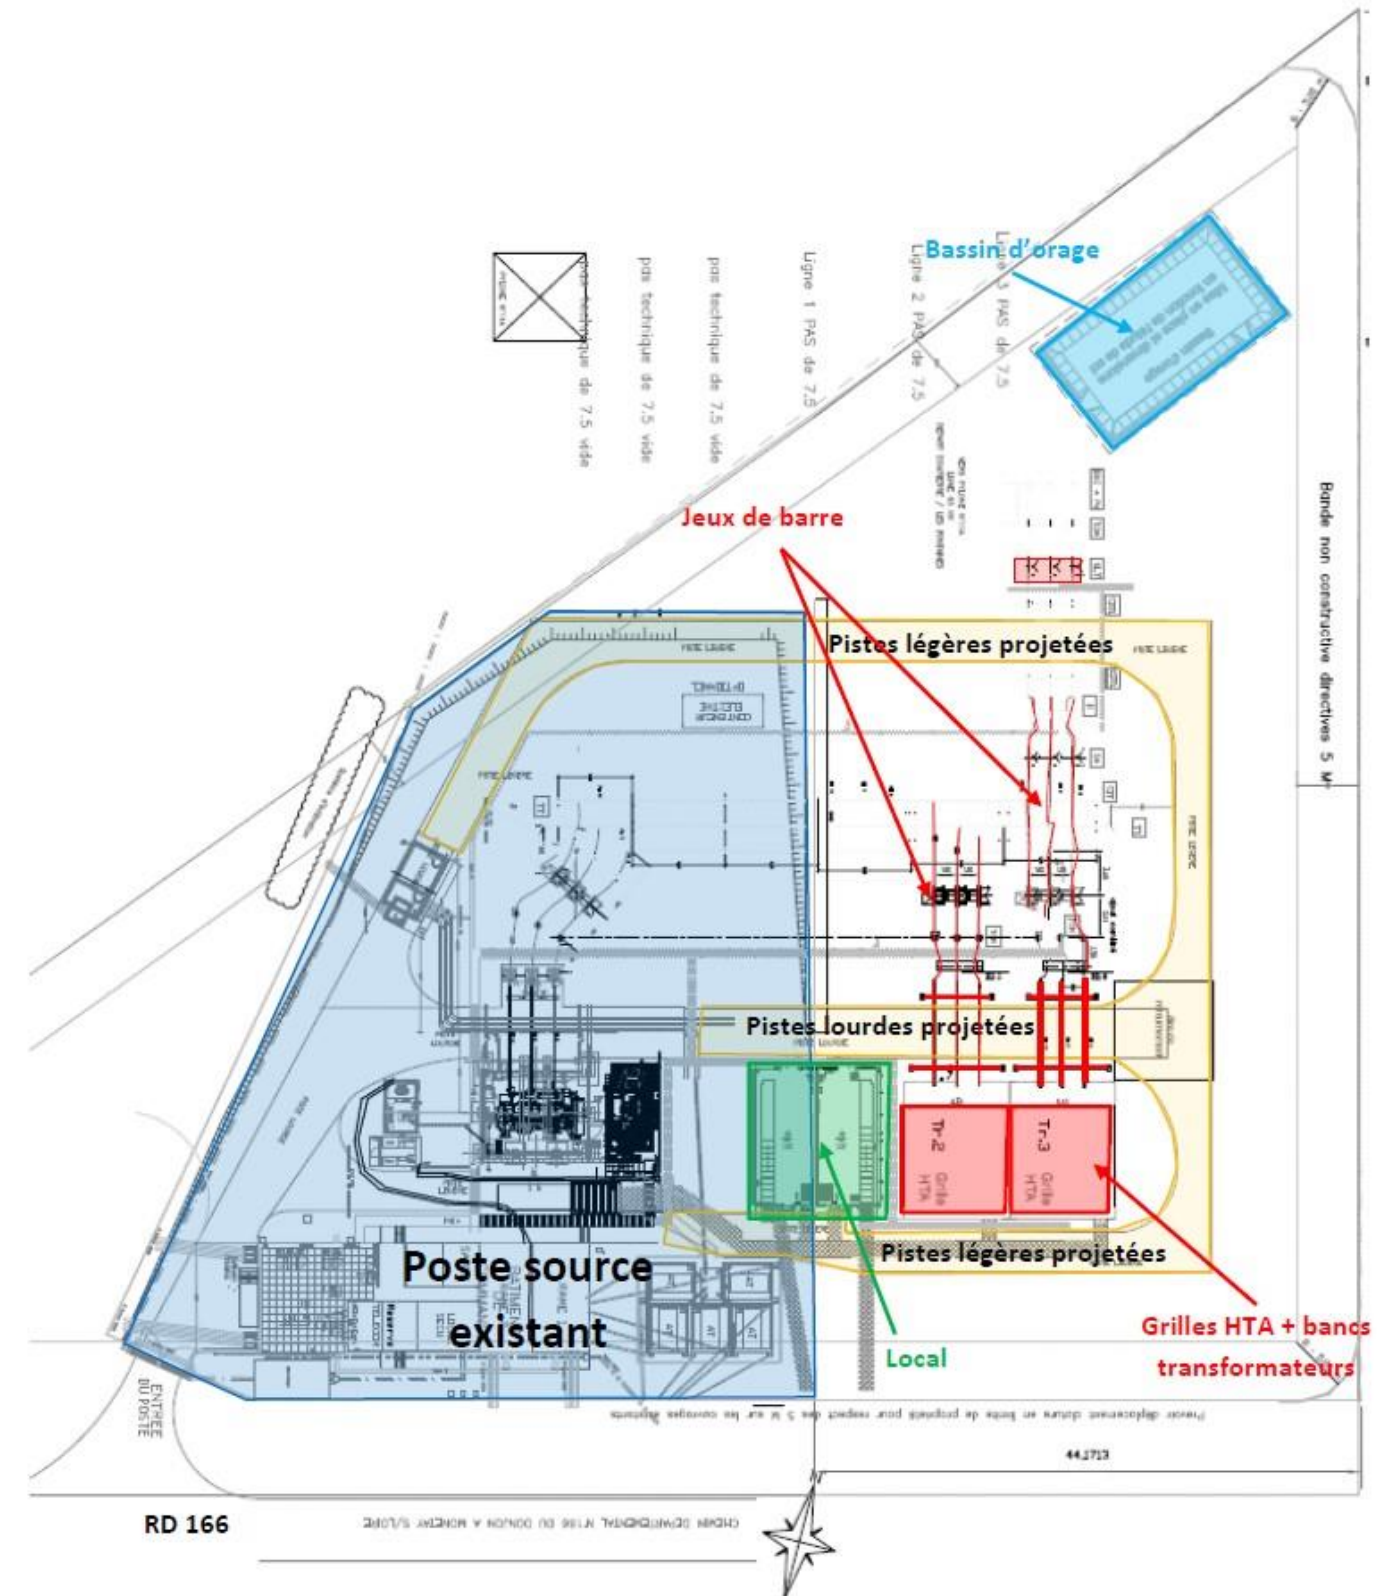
PLAN MASSE DU PROJET, ENEDIS
